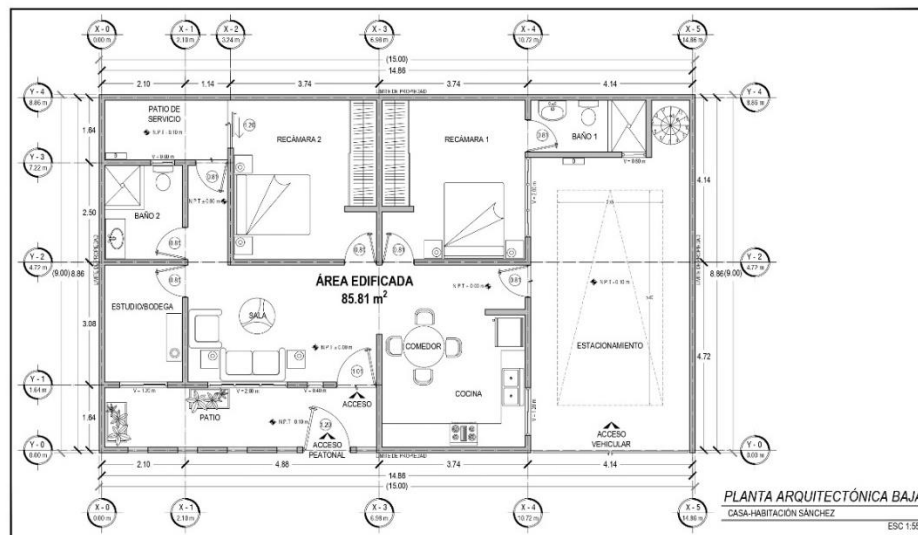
Planta arquitectónica resultante de la propuesta hecha en el anteproyecto (elaboración propia) (véase en anexos).
